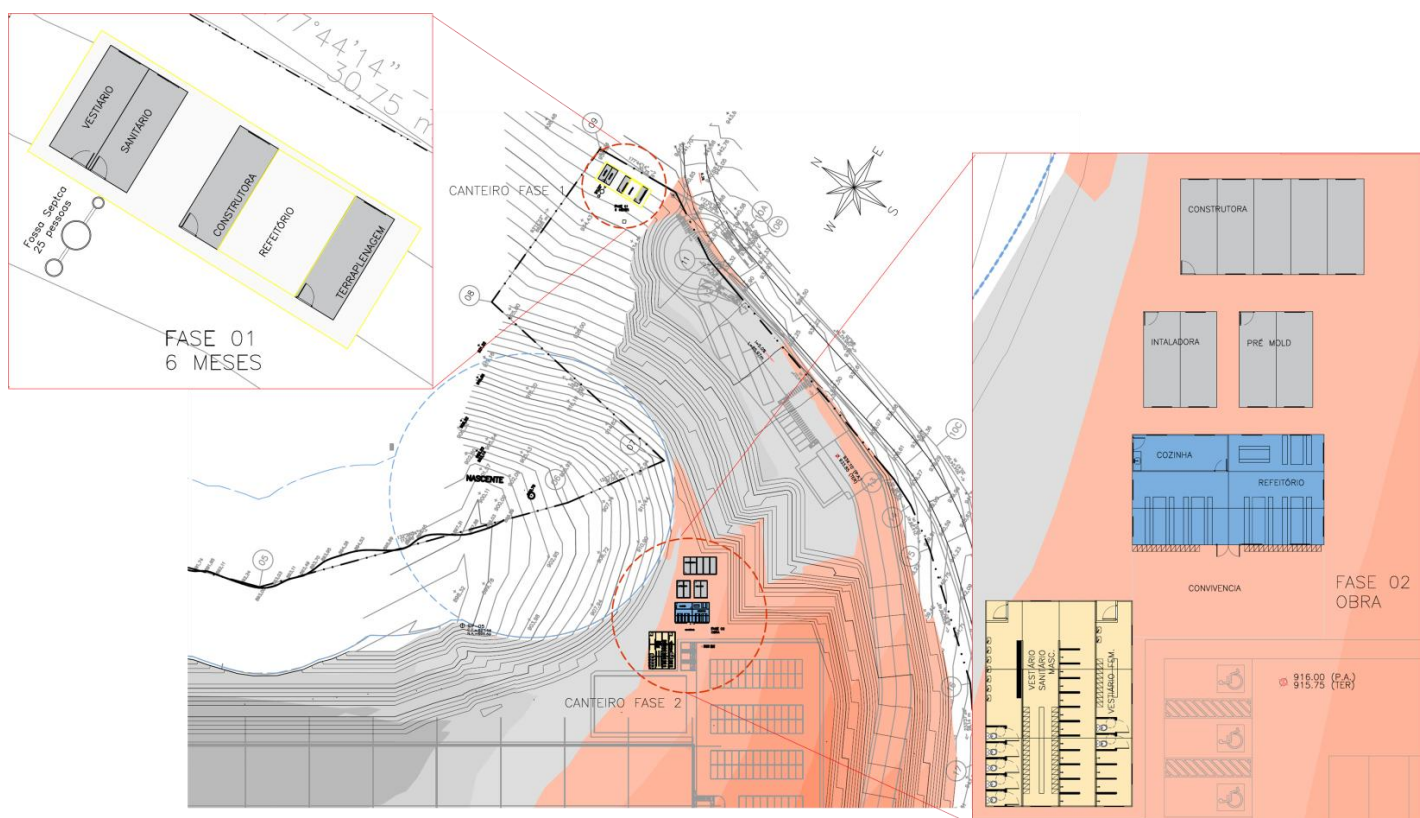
Croqui de instalação e localização do canteiro de obras do empreendimento na fase 1 e na fase 2.
